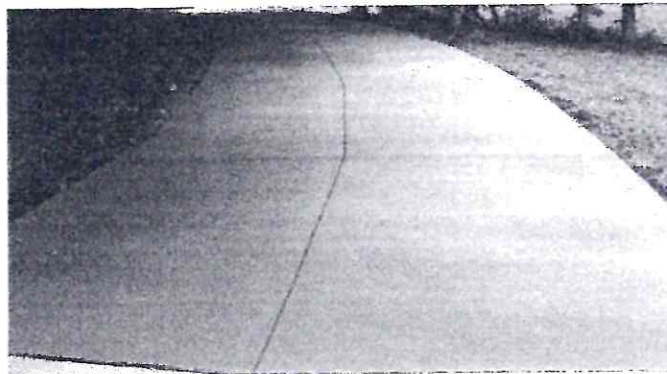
Piso em concreto desempenado com juntas de dilatação em madeira. Fonte: <https://www.fazfacil.com.br/reforma-construcao/calçada-de-cimento/>.
